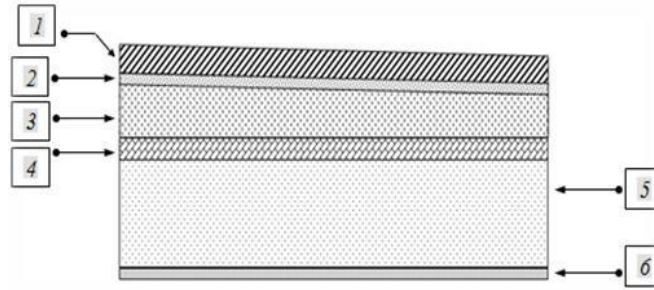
Coupe verticale du plancher terrasse à dalle pleine.
